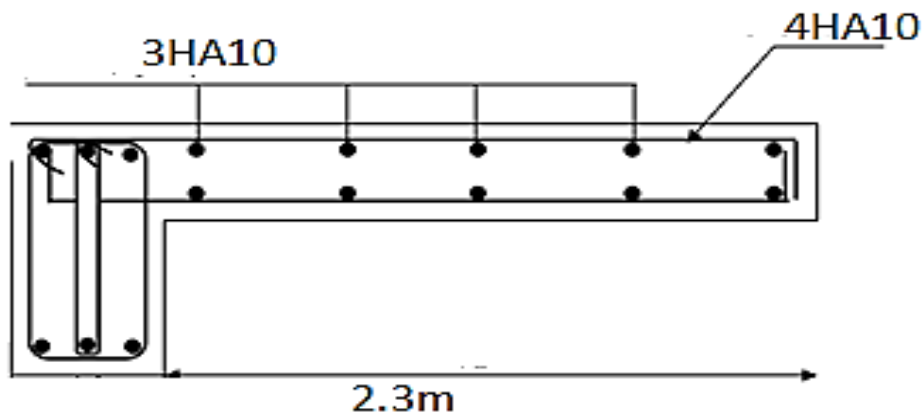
2 Schéma de ferrailage sur deux appuis (balcon).
